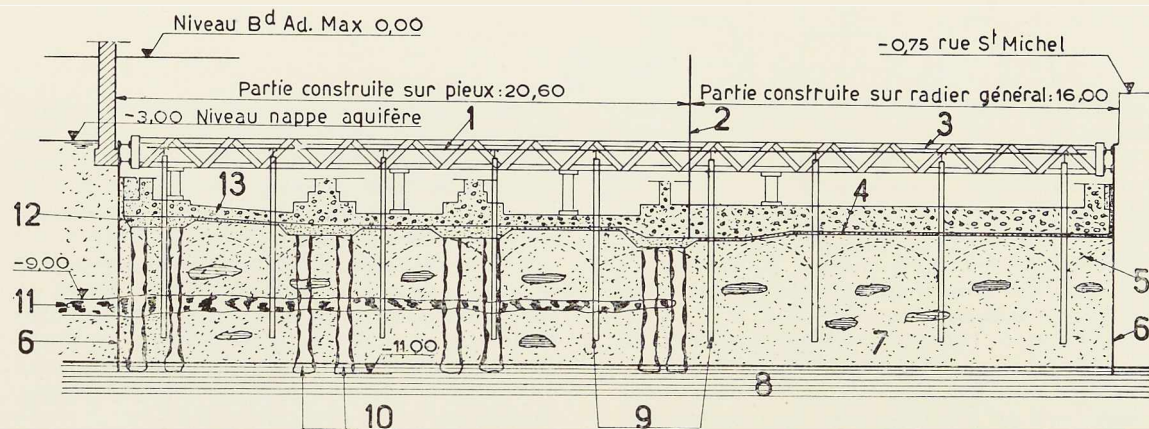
Coupe schématique de la fouille pour la construction de l'Hôtel Atlanta à Bruxelles.
